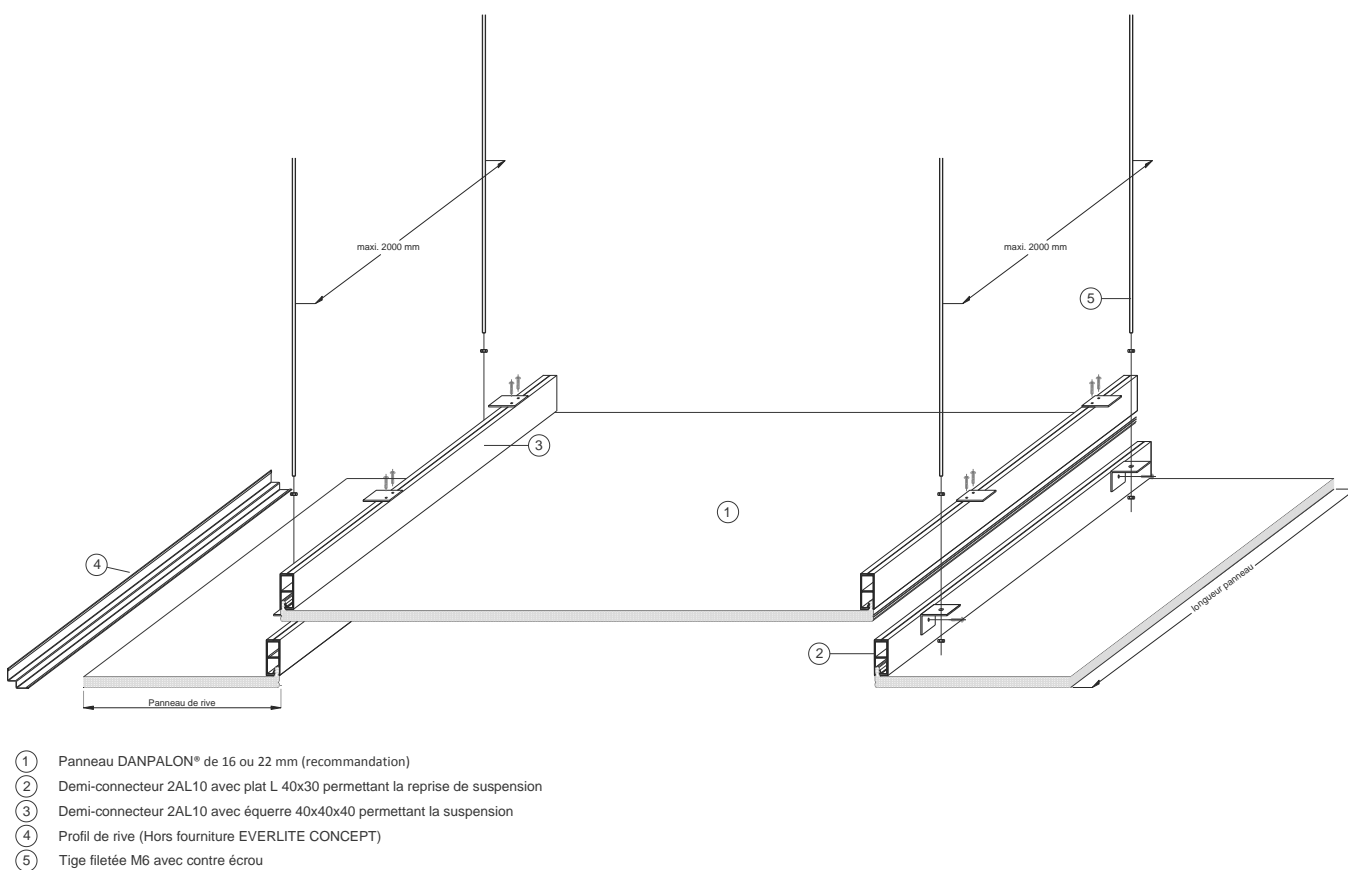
Trappe d'accès – système DANPALON® application plafond suspendue
